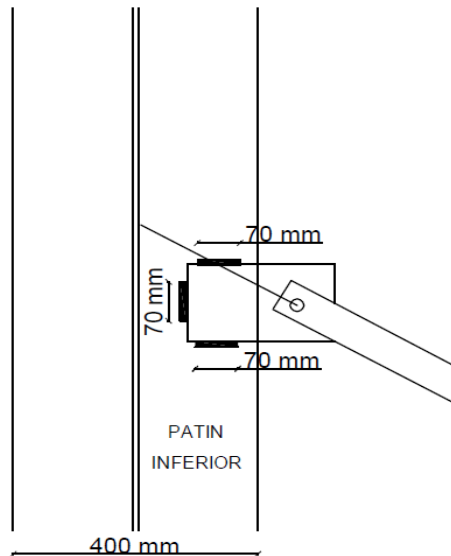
Unión de patín inferior con placa mediante soldadura de filete. Elaborado por: Autor
